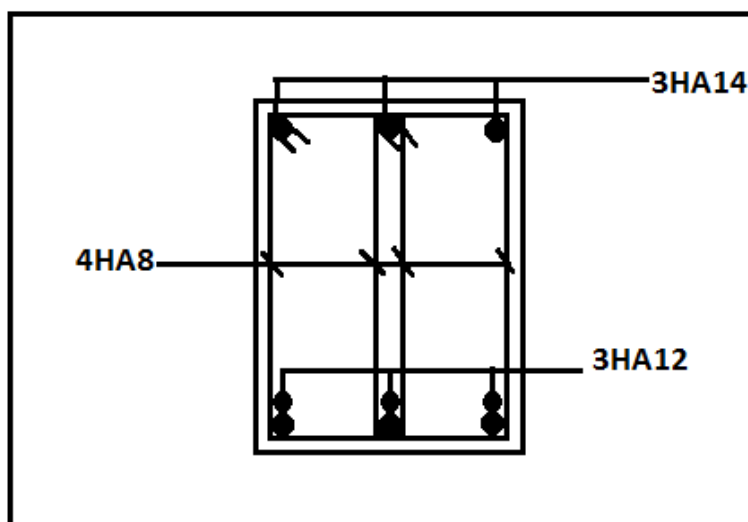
Ferrailage en travée d'une poutre principale.
